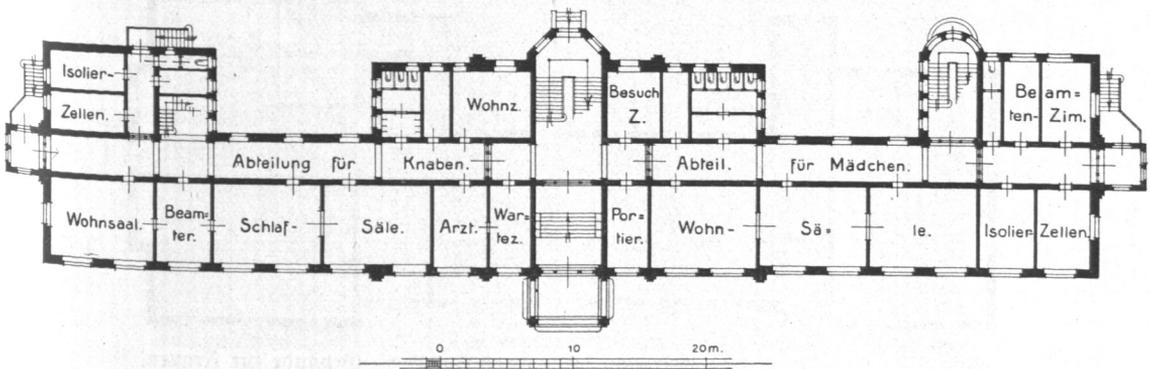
Verwaltungsgebäude des Waisenhauses, Grundriß.
